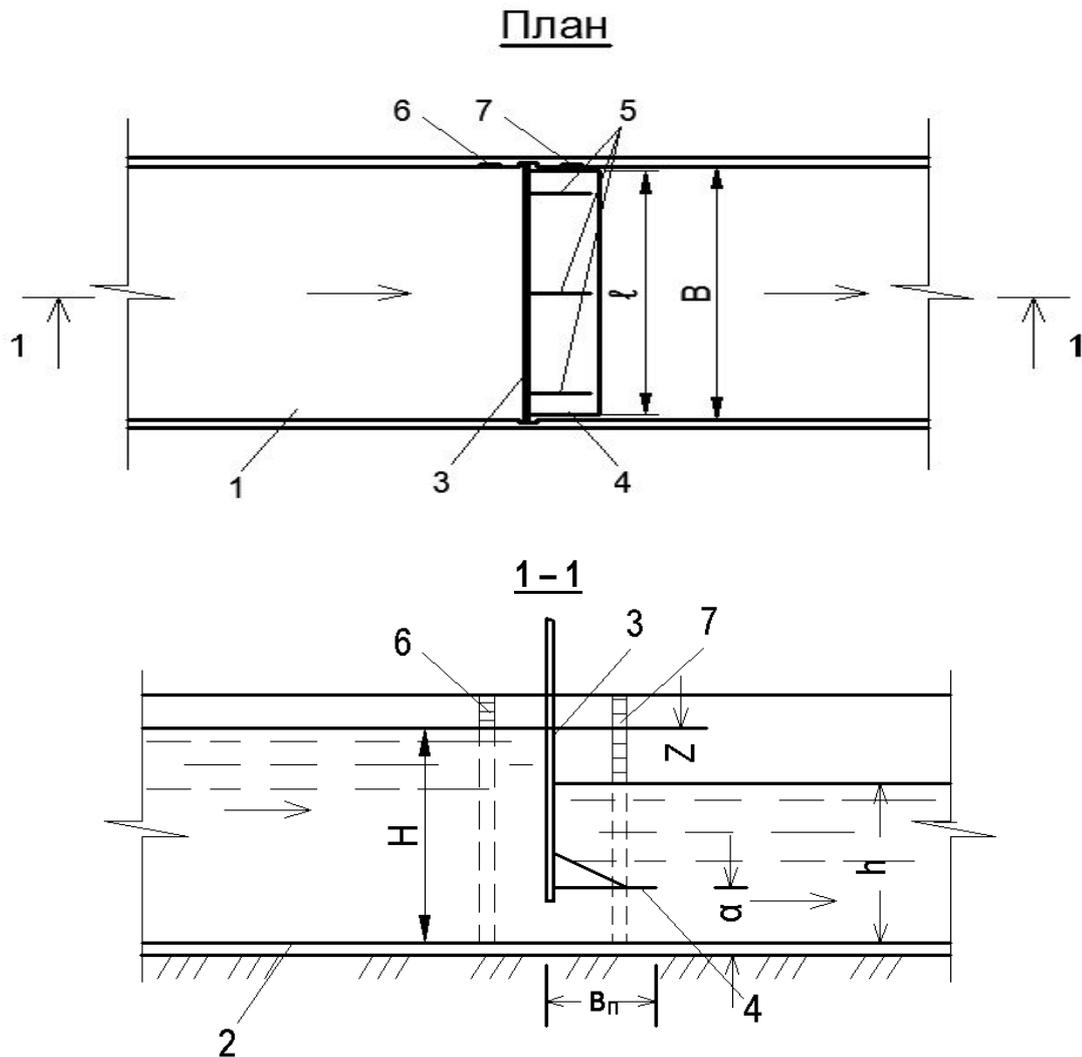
Схема водомера типа «Прямоугольный насадок» на водотоке с прямоугольным сечением
